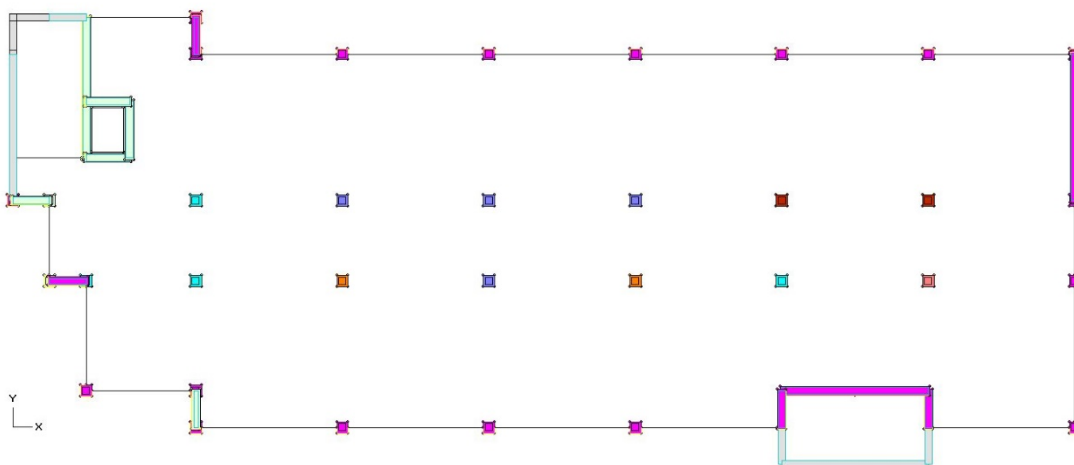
Расчетное поперечное армирование в зоне продавливания
